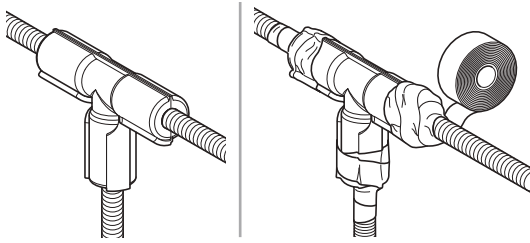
Conexión Geberit para Te (aislamiento) con cinta sellante
